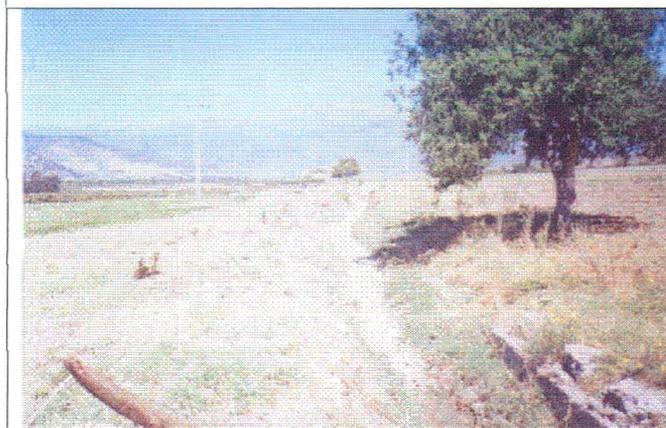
Sección. Tramo del canal posterior al tramo 4 revestido.
